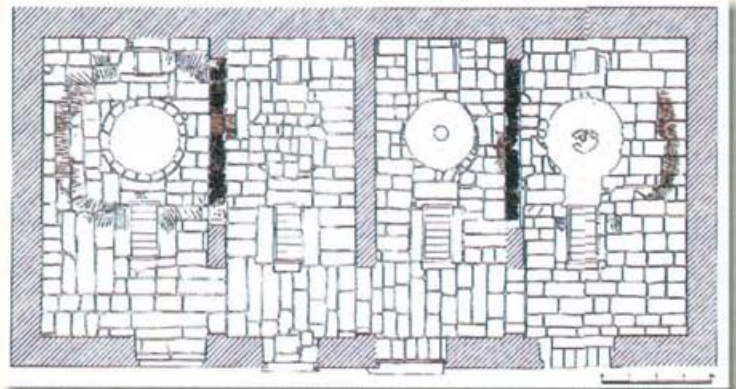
Planta da Fábrica de Baixo, ao nível do pavimento.
